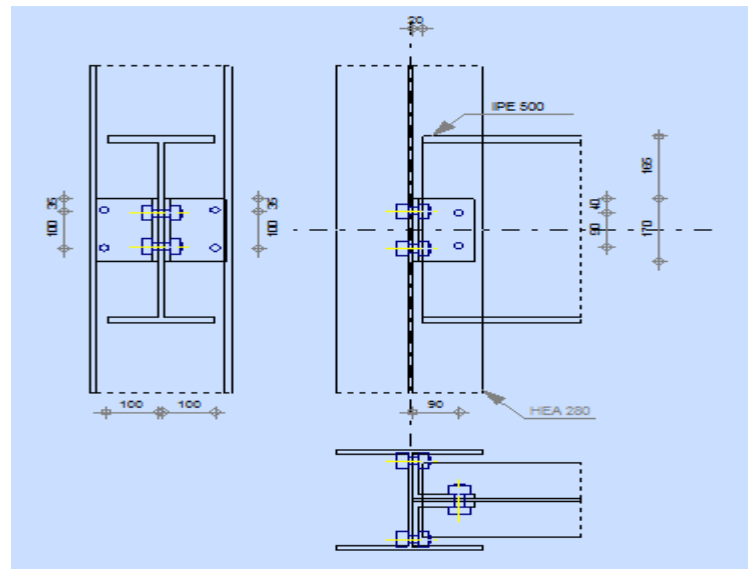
Représentation de l'assemblage poteau-poutre maitresse
